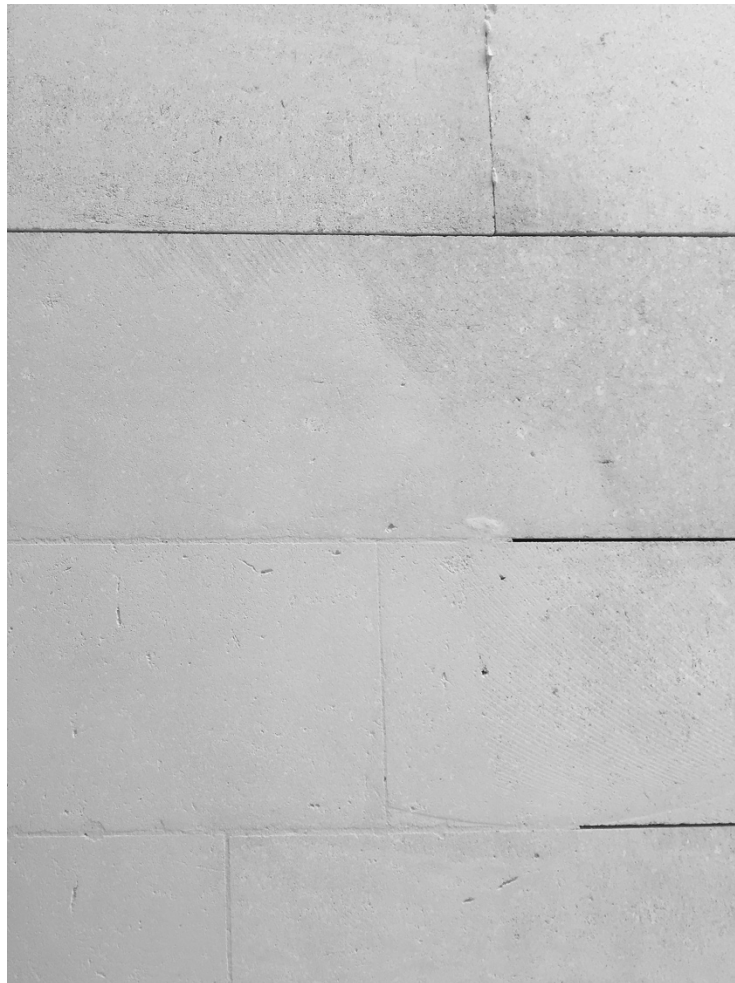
Traitement de la surface de la Pierre dans le Projet de Logement du Plan D'Aou Par Land Bag Architectes.
